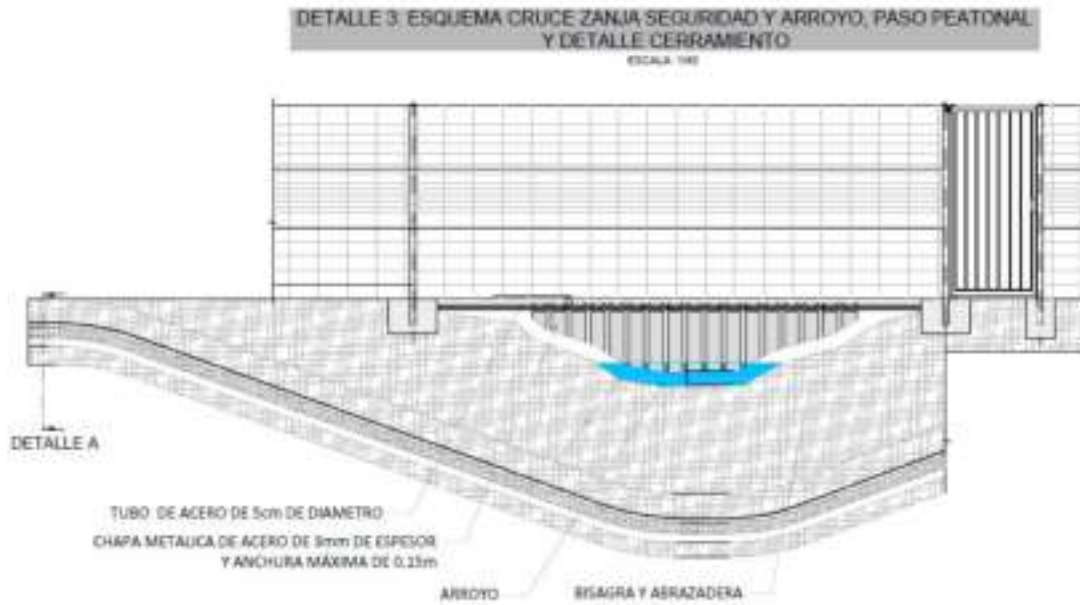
Cruce de zanja de seguridad y vallado perimetral con arroyo
